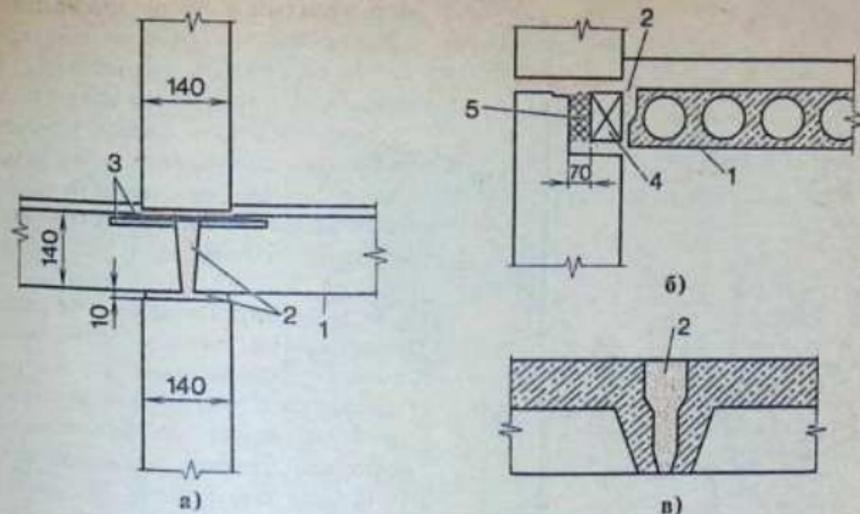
Стыки между плитами перекрытий и покрытий: а — перекрытия панельного здания с несущими внутренними панелями, б — перекрытий с торцовыми наружными блоками, в — ребристых плит покрытия; 1 — панели (плиты) перекрытия, 2 — раствор, 3 — закладные детали на сварке, 4 — бетонный камень, кирпич, 5 — пакет теплоизоляции
